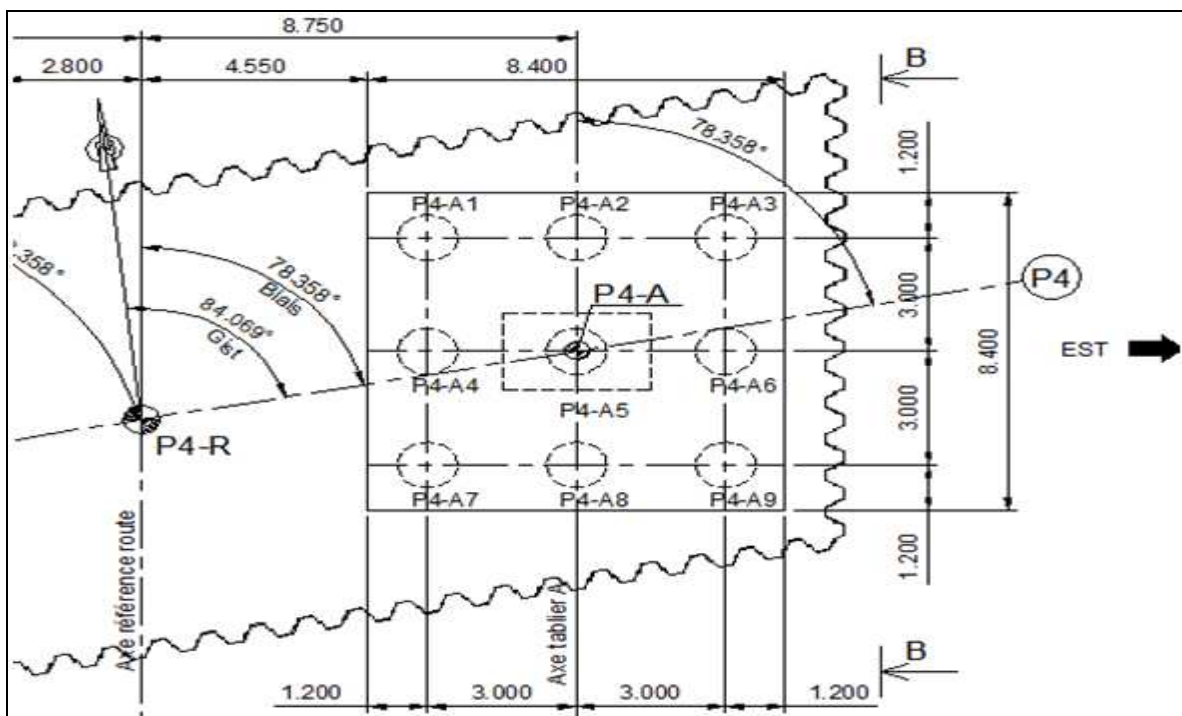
Vue en plan d'exécution des pieux d'une pile (P4)
